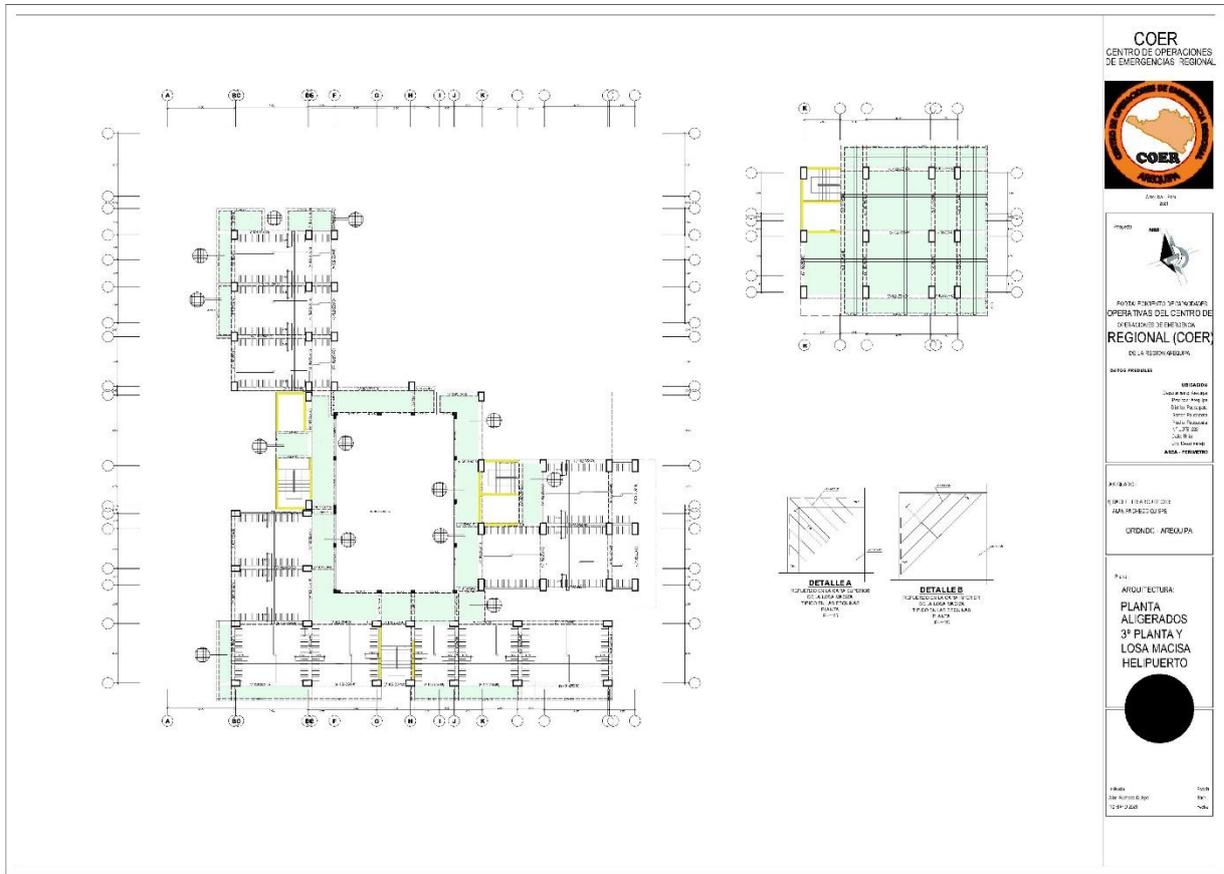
Aligerados 3º Planta y losa maciza de helipuerto
